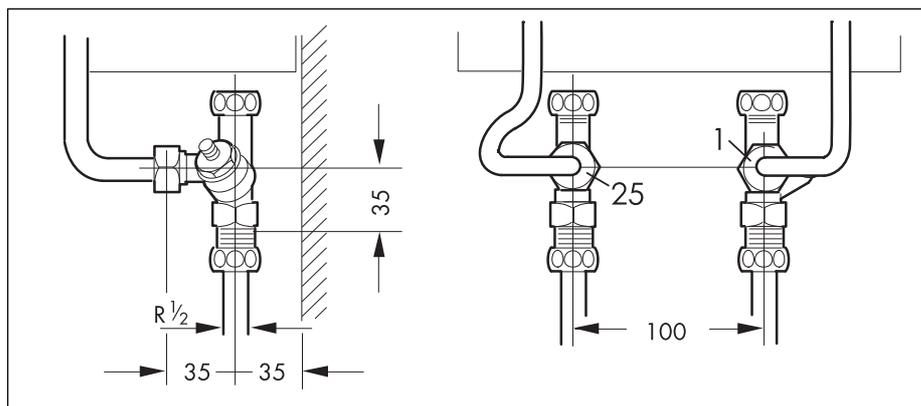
Открытый монтаж, подключение холодной воды к напорной арматуре; Размеры в мм
